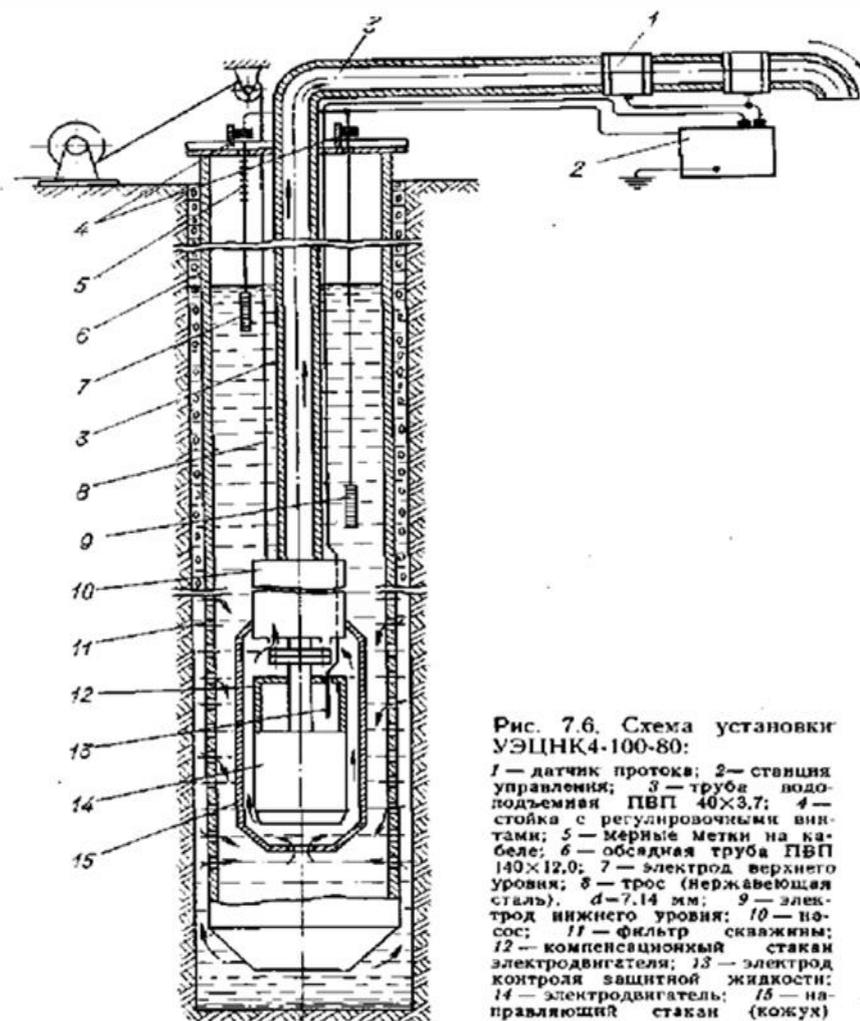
Схема установки УЭЦНК4-100-80:
